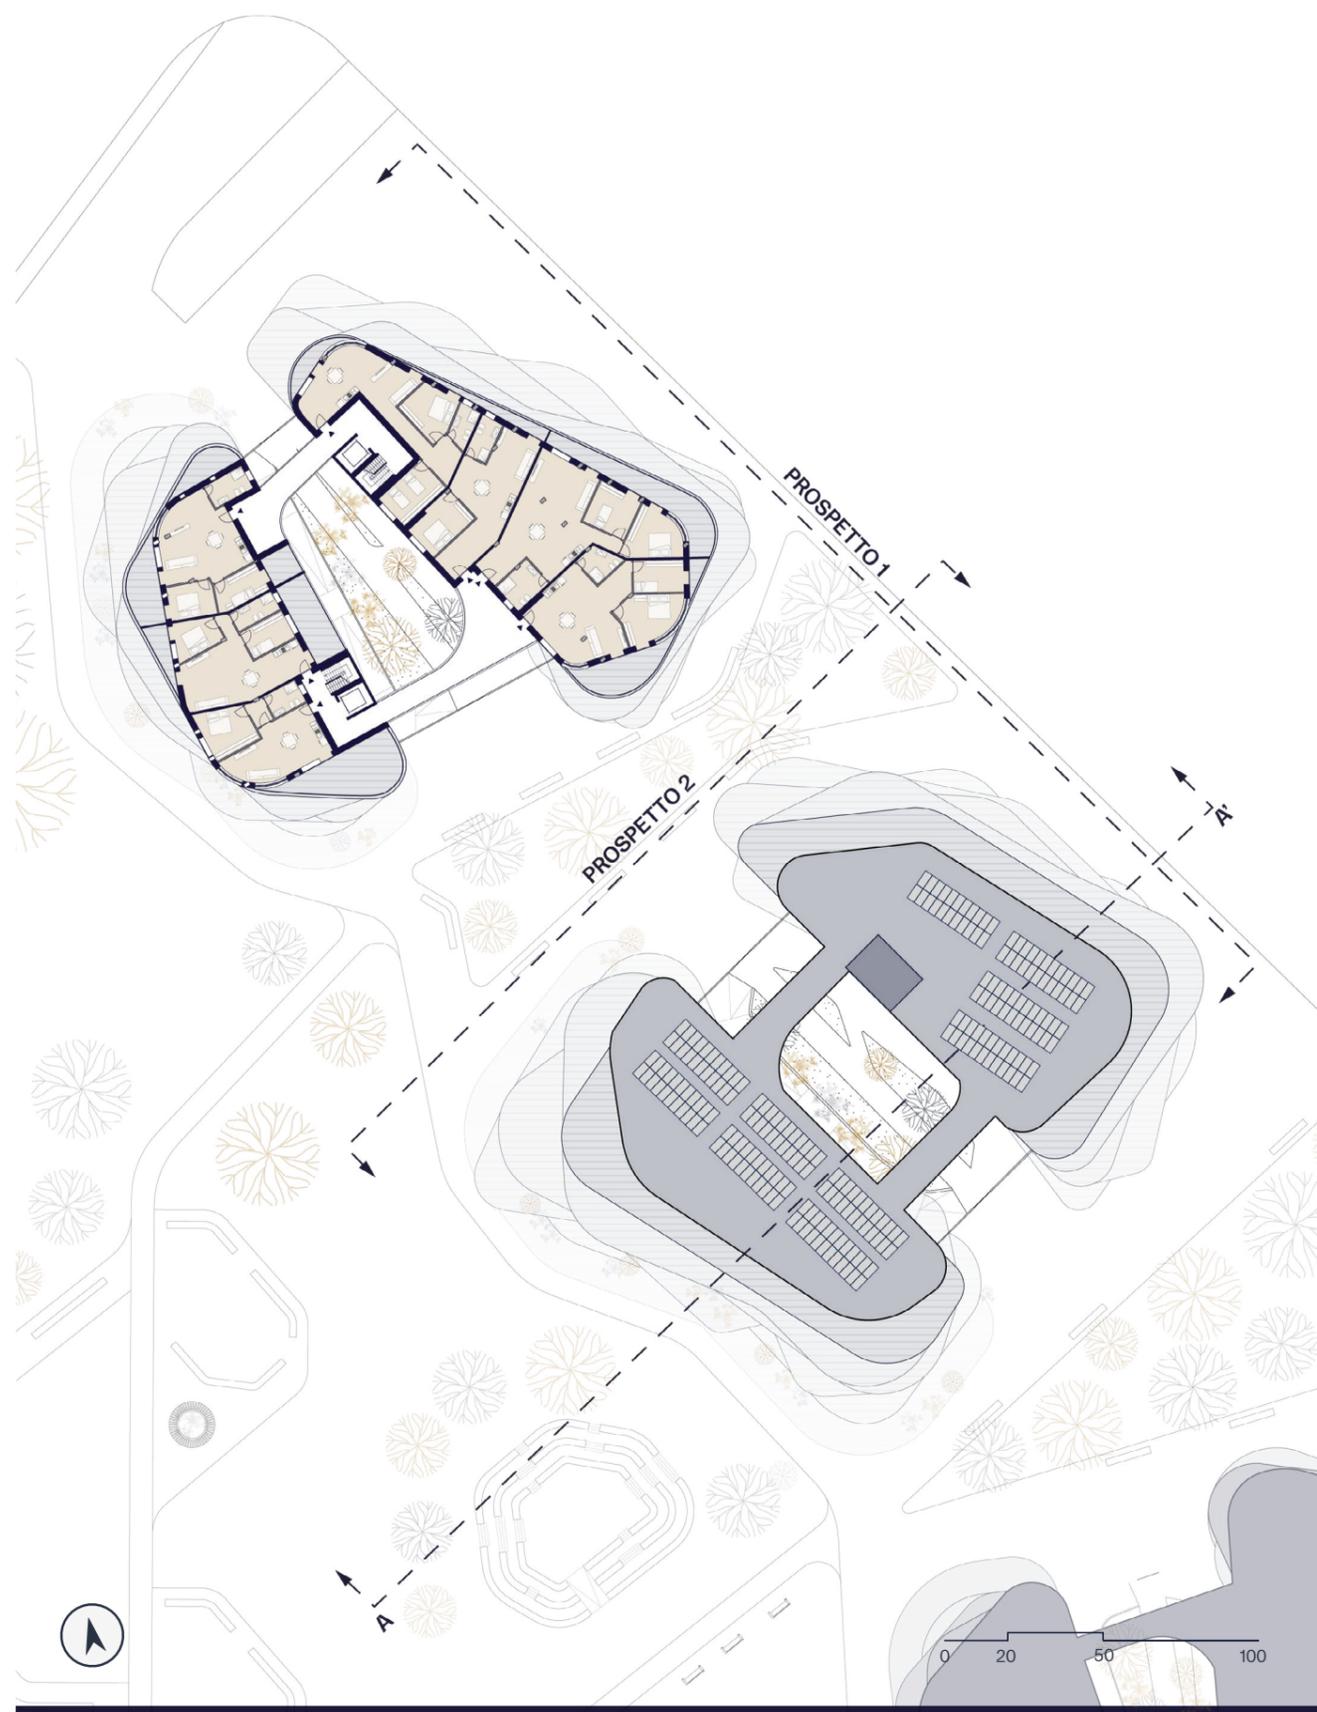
Focus planimetrie alloggi piano quinto Tipologia 1
